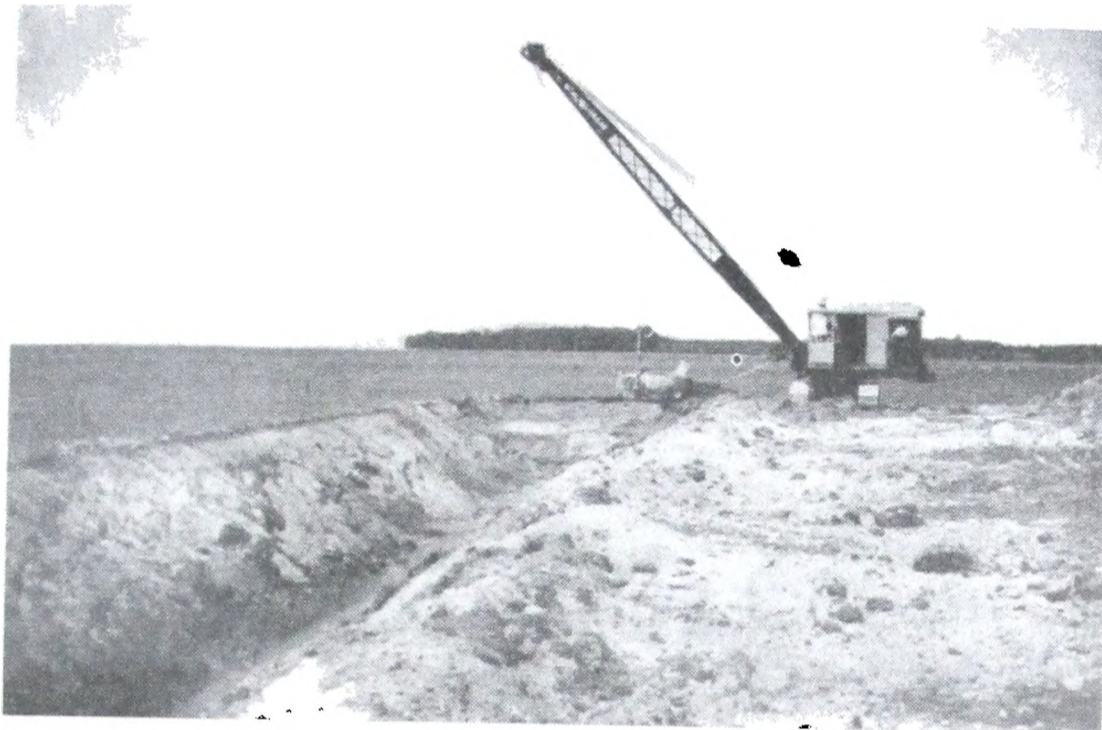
Canal de Guido al mar. Puente compuerta en el Km. 6,5.
